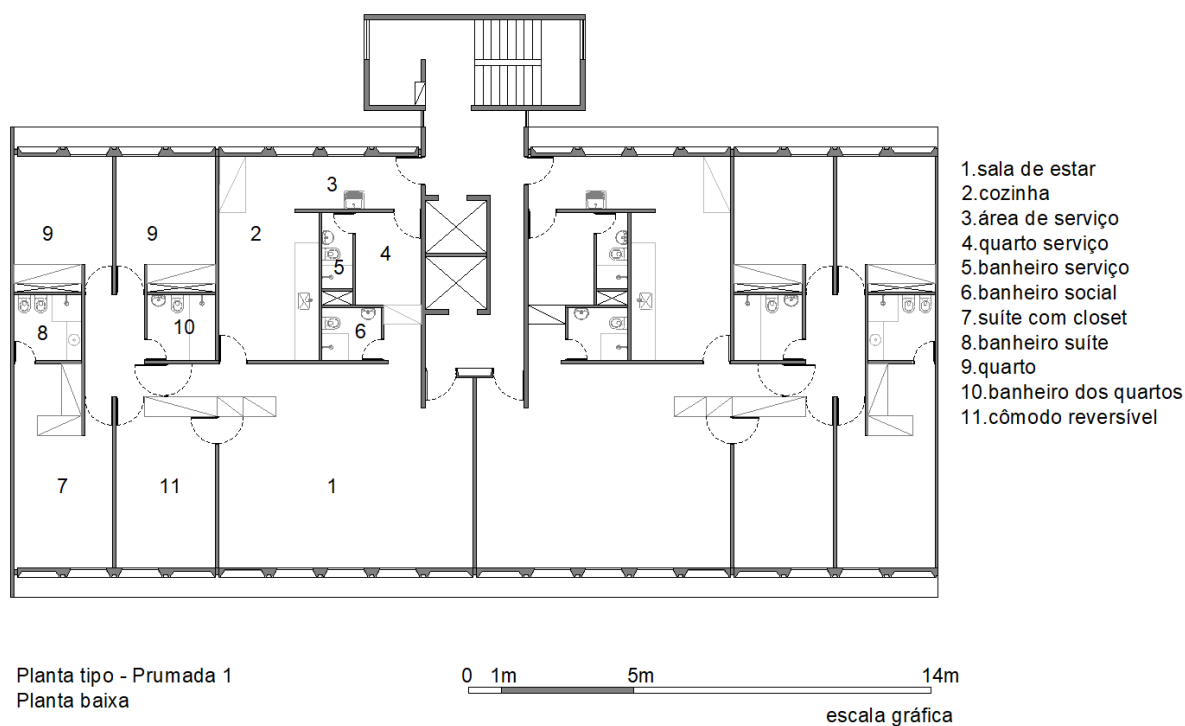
Planta baixa do apartamento tipo do R3. Fonte: da autora.
